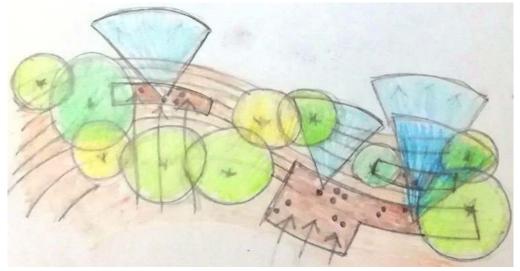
Propuesta inicial en planta de las plataformas con sus posibles visuales
